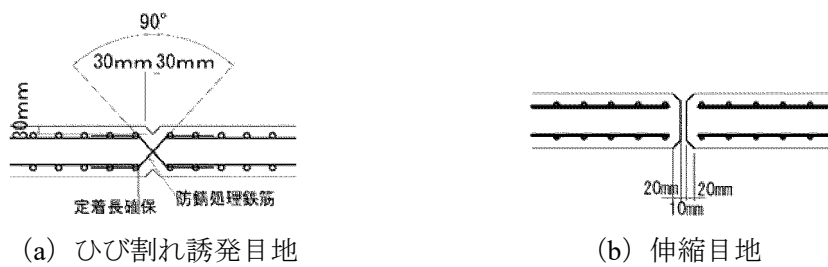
ひび割れ誘発目地及び伸縮目地の形状（平面図）
